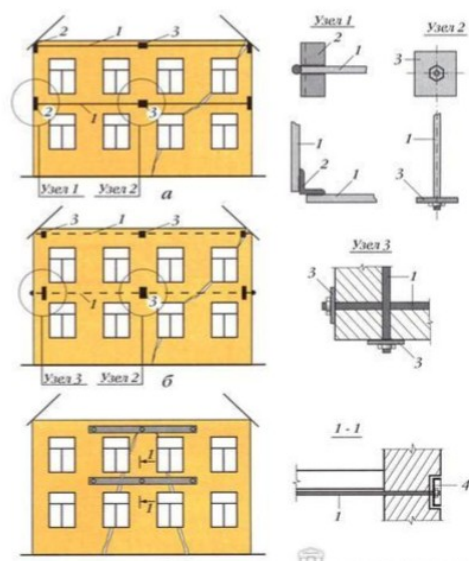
Усиление стен: а, б -стальными тяжами с наружной (а) и внутренней (б) сторон здания; в -установкой ненапрягаемых тяжей; 1 -тяж; 2 -уголок; 3 -опорная стальная пластинка; 4 -швеллер
